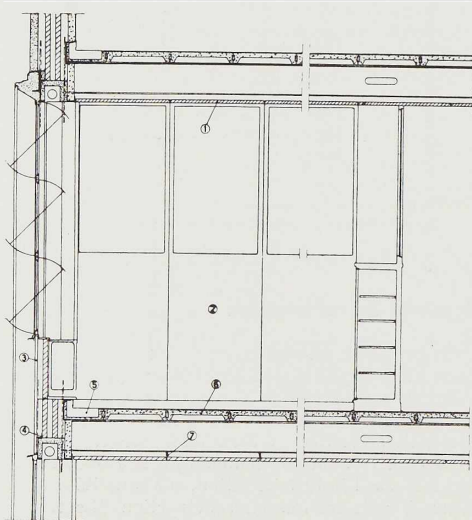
Coupe dans les murs de façade et dans le plancher.
